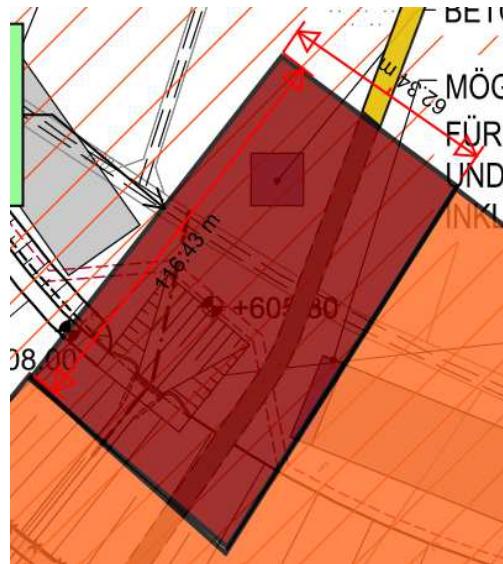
Baufeld Betonbau am Schachtkopf ESR Speichersee
